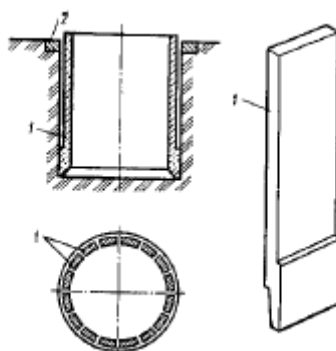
Сборный опускной колодец из вертикальных панелей: 1 – панели; 2 – форшахта
